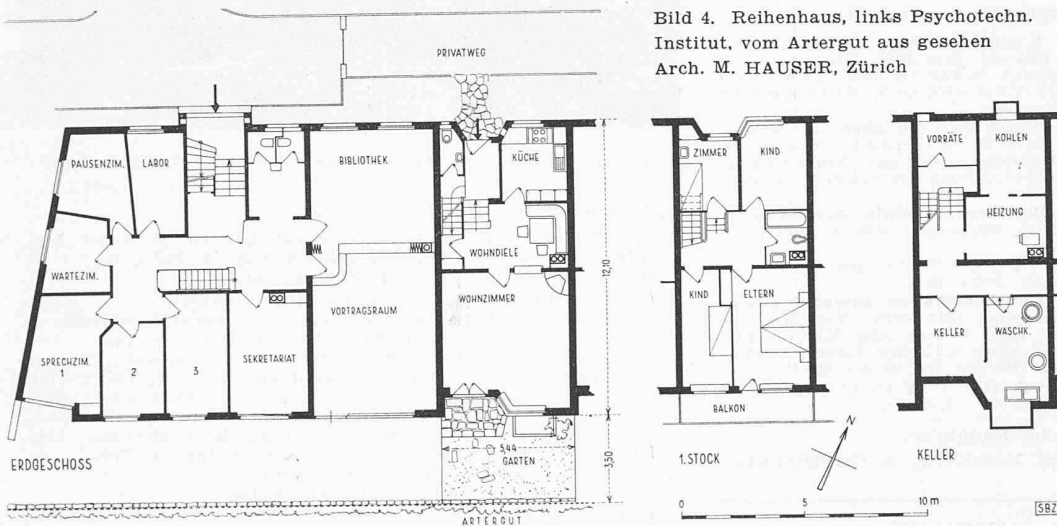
Psychotechnisches Institut und Reihenhäuser am Artergut in Zürich, Grundrisse 1 : 300
